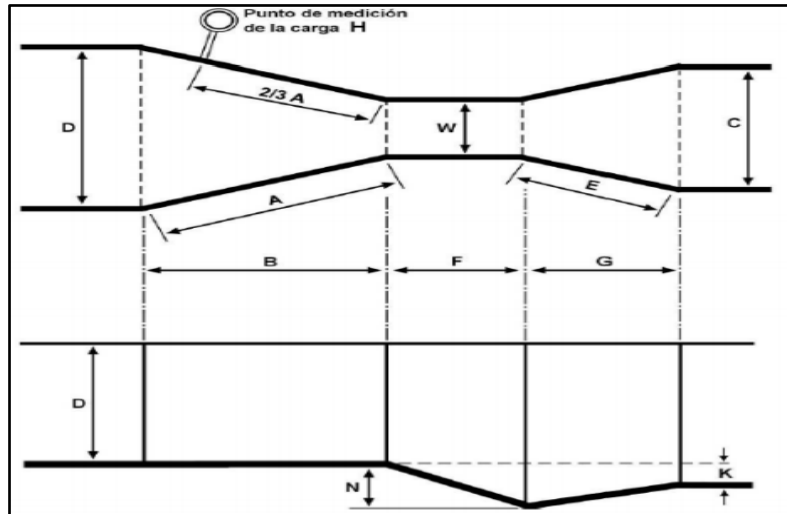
Imagen referencial de vista de planta de una canaleta Parshall.
